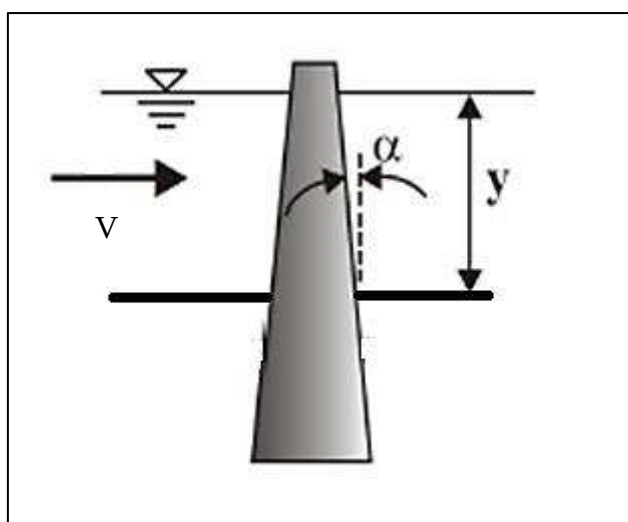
14 Vista lateral de pilar con estrechamiento hacia arriba.
